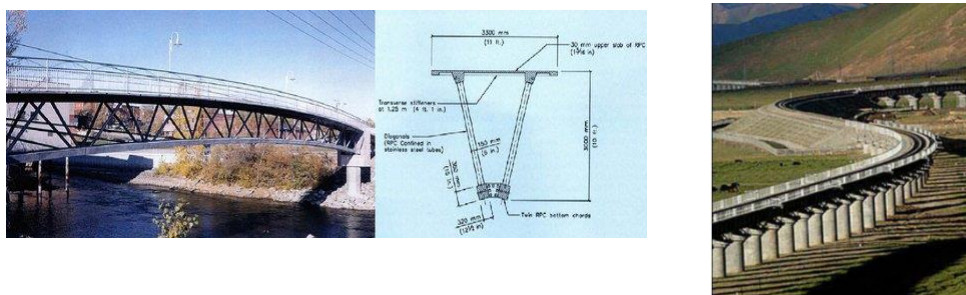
Ponte pedonale di Sherbrooke, Fig.2 Qinghai – Tibet Railway Bridge
